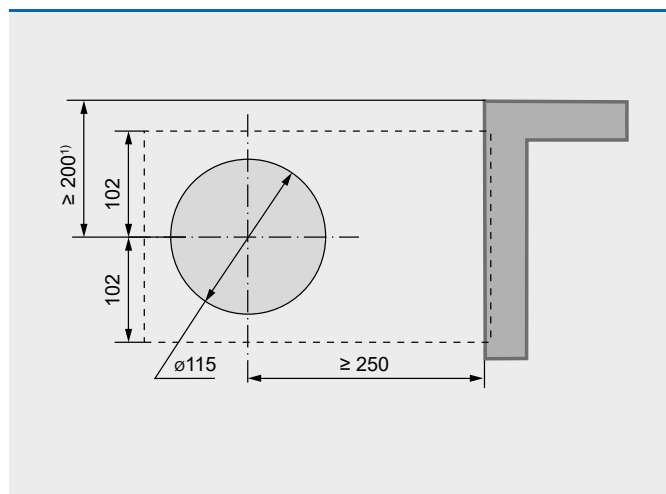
apertura parete aV100 Corner, canale piatto 400 mm
